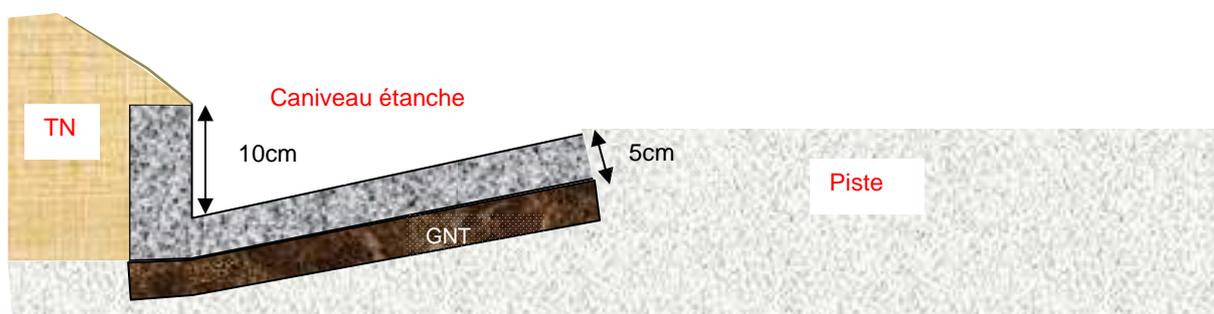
Coupe type du caniveau coulé en place bordant la piste
